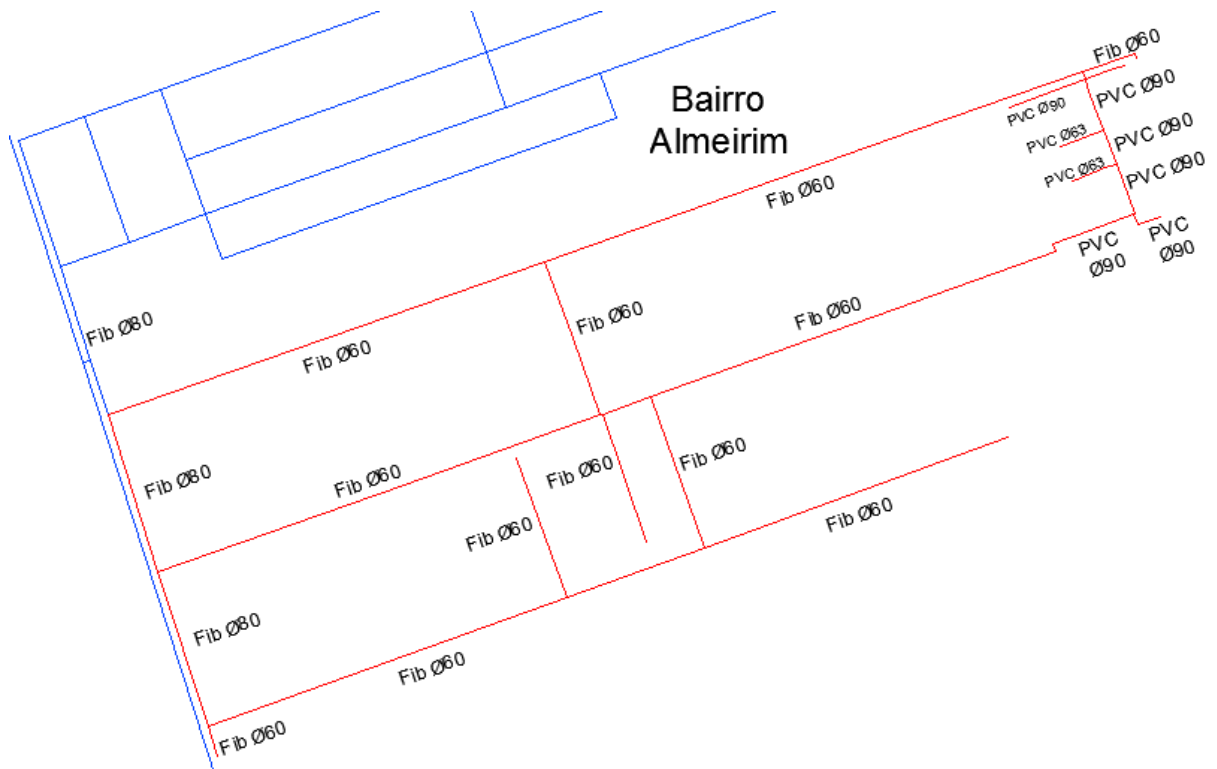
Traçado e materiais das condutas principais no Bairro de Almeirim (a cor vermelha).
